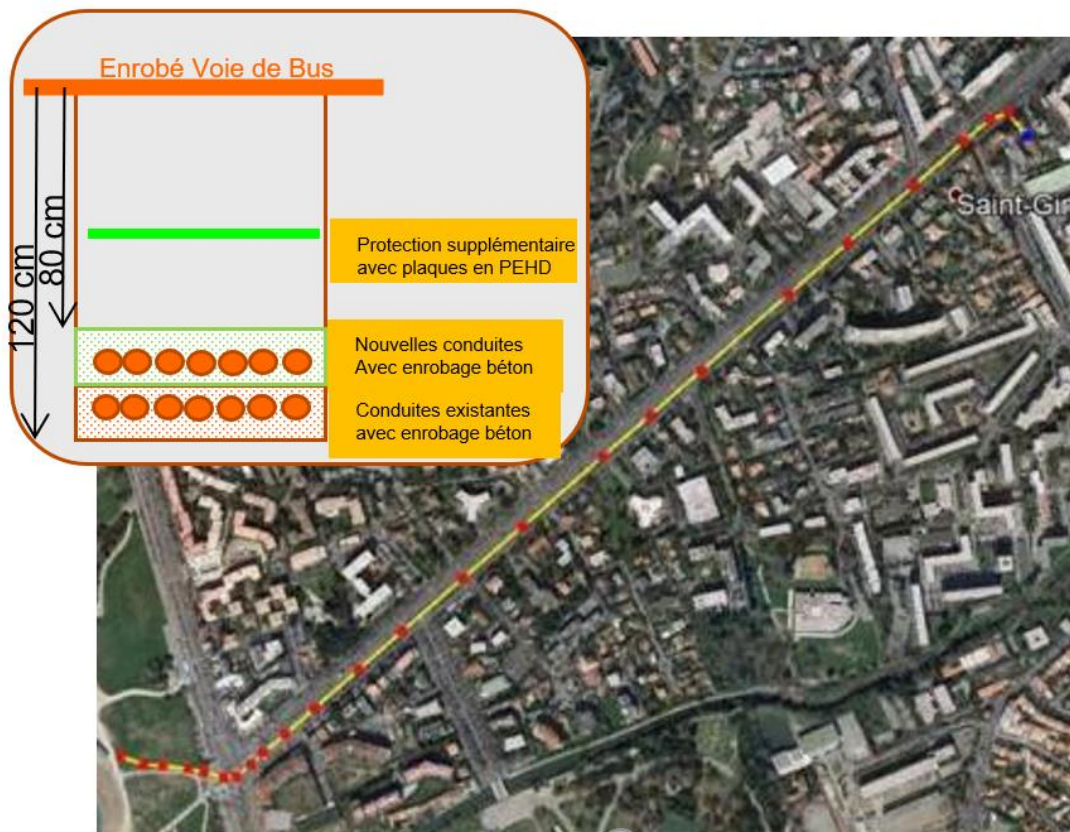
Localisation du tracé terrestre et vue en coupe de l'installation
